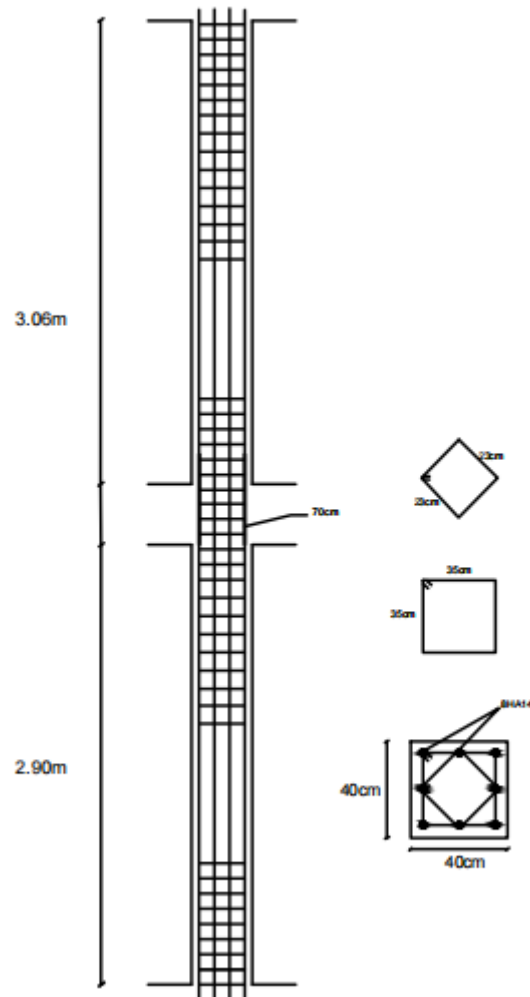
Schéma d'un ferrailage de poteau (40x40).
